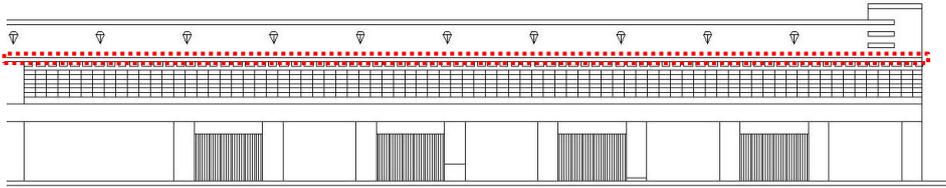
Tampak Depan Bangunan Toko 1 lantai
